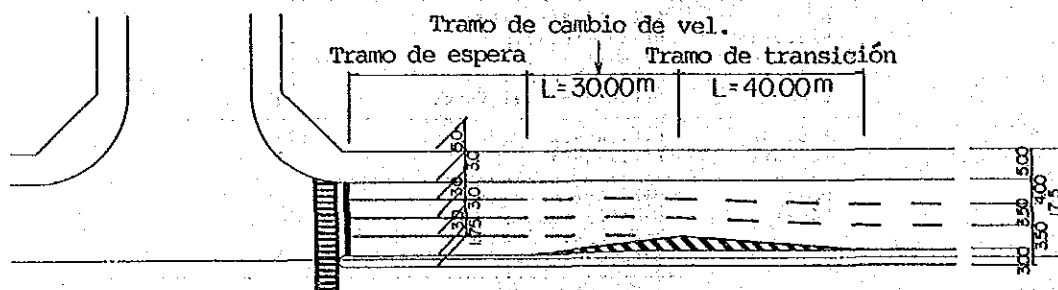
PLANO TIPICO DE LA INTERSECCION A NIVEL
